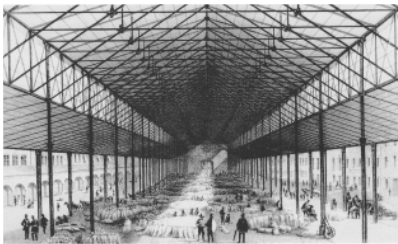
Piața din München (Schrannenhalle) - contravântuirile suplimentare, ce se puteau observa atât la nivelul fermelor principale, cât și în cadrul elevațiilor dintre cele două acoperișuri, aveau să schimbe într-o bună măsură percepția spațiului. Fluiditatea se păstrează la nivelul util, datorită elementelor verticale filigrane, dar acoperișul primește și mai multă consistență.
